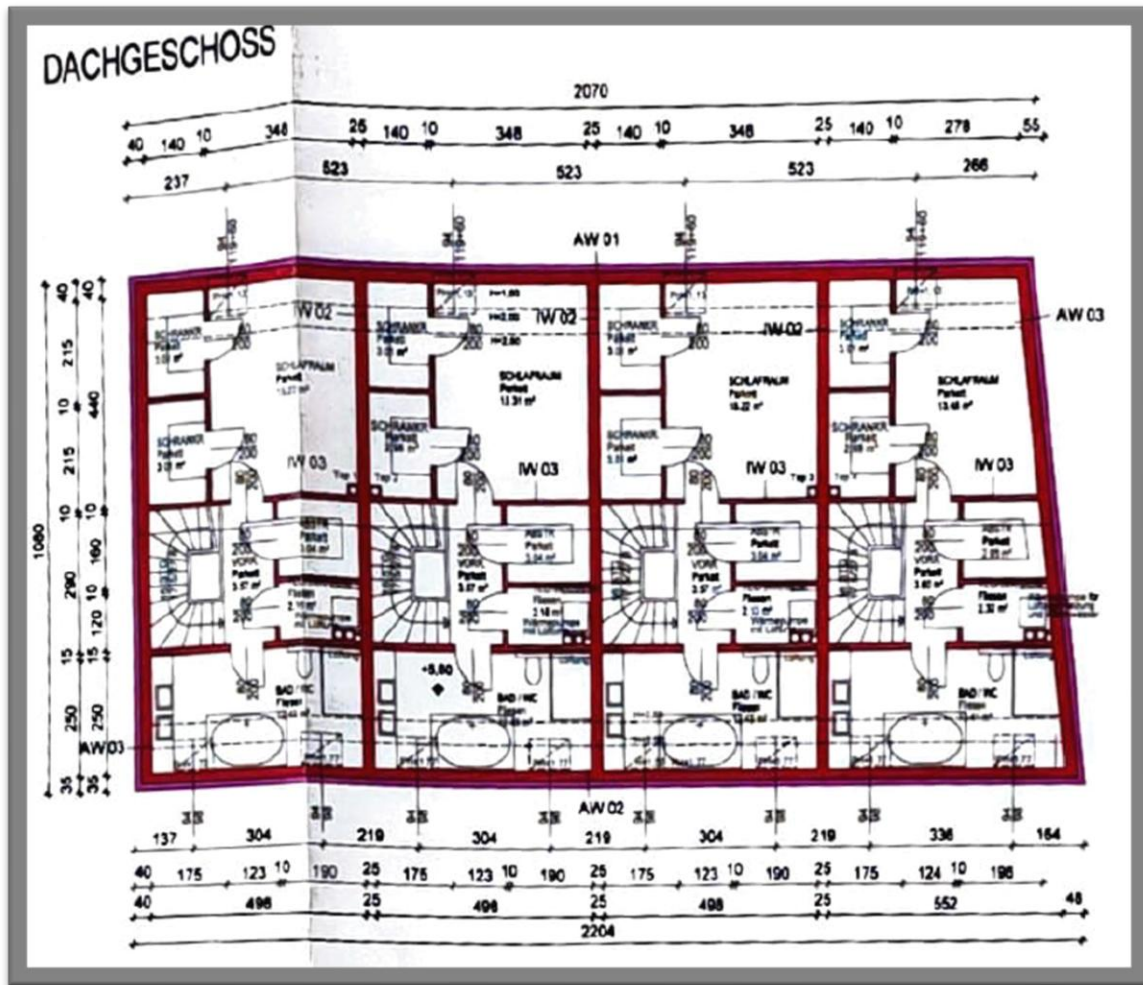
Grundriss DG - Haus 1-4
